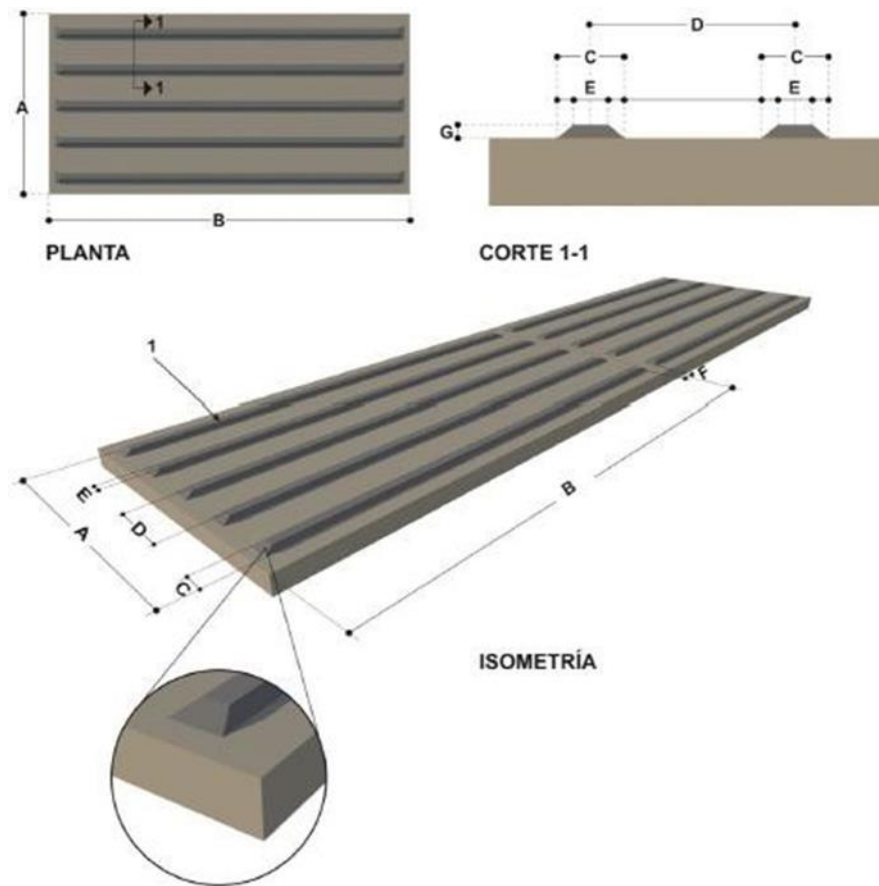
Patrón de alto relieve trapezoidal segmentado Perfil pirámide truncada
